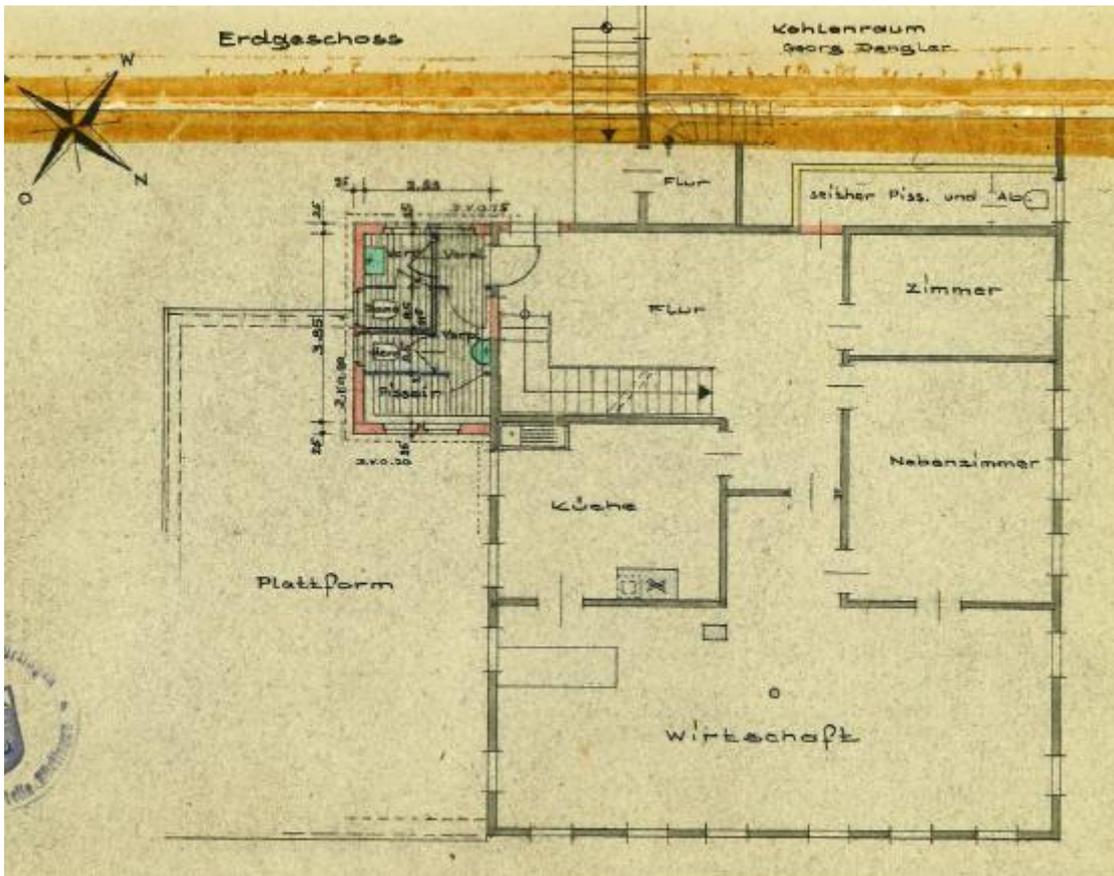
Bestandsplan Grundriss Erdgeschoss, zugesendet am 02.03.2023 durch die Stadt Aichtal
